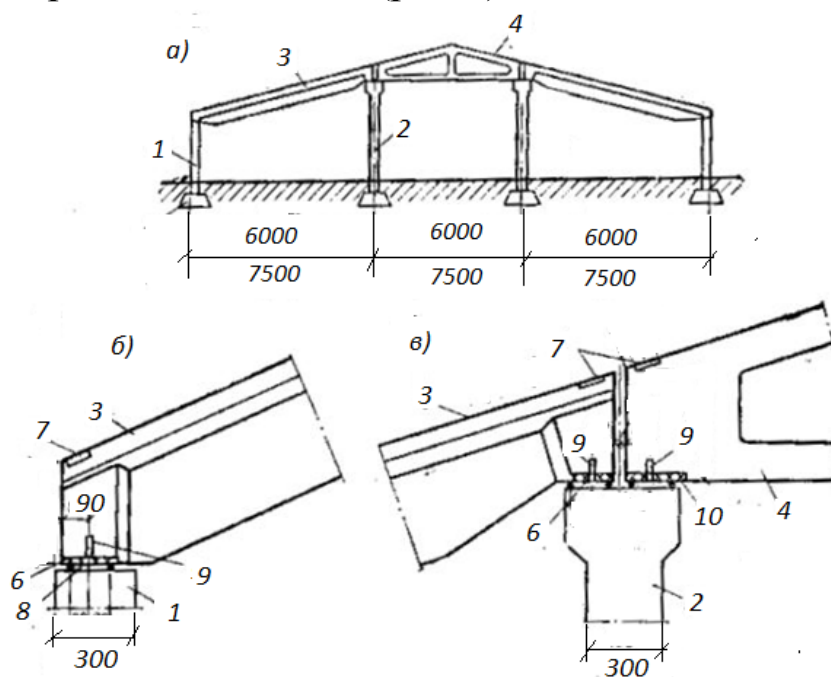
Схема железобетонного каркаса 3- пролетного сельскохозяйственного здания с использованием односкатных балок и безраскосных треугольных ферм:
